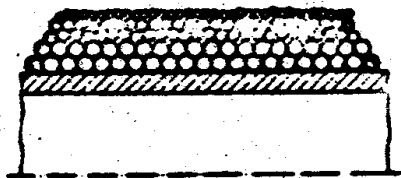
Condotta in pressione rinforzata mediante avvolgimento di filo d'acciaio a sezione circolare.
